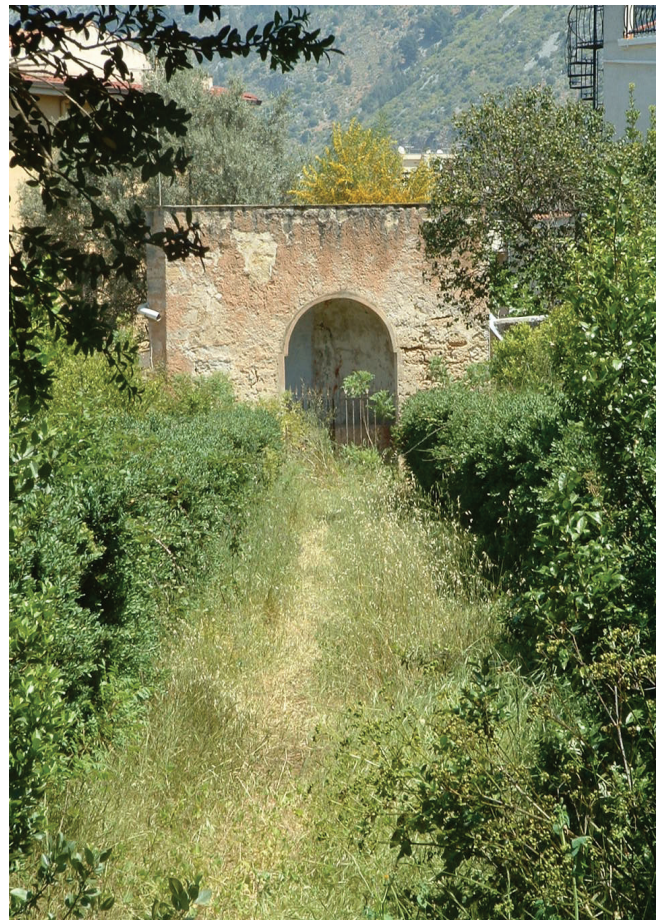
Il viale diagonale che dalla vasca centrale conduce al belvedere a destra dell'edera centrale, per chi volge le spalle alla terrazza. Sebbene integra nel suo volume, purtuttavia l'intonaco di protezione si è del tutto staccato dalle sue pareti. La parte destra è gravemente degradata perchè soggetta ad avanzati e profondi fenomeni di alveolizzazione dell'arenaria tufacea.
